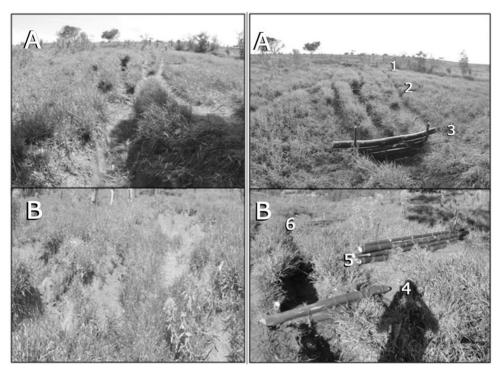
Área de construção das barreiras de bambu a montante (A) e a jusante (B) da vertente, na propriedade de Getulina
